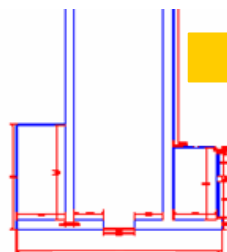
MUROS NAVE 2 (SAGRADO CORAZÓN)
